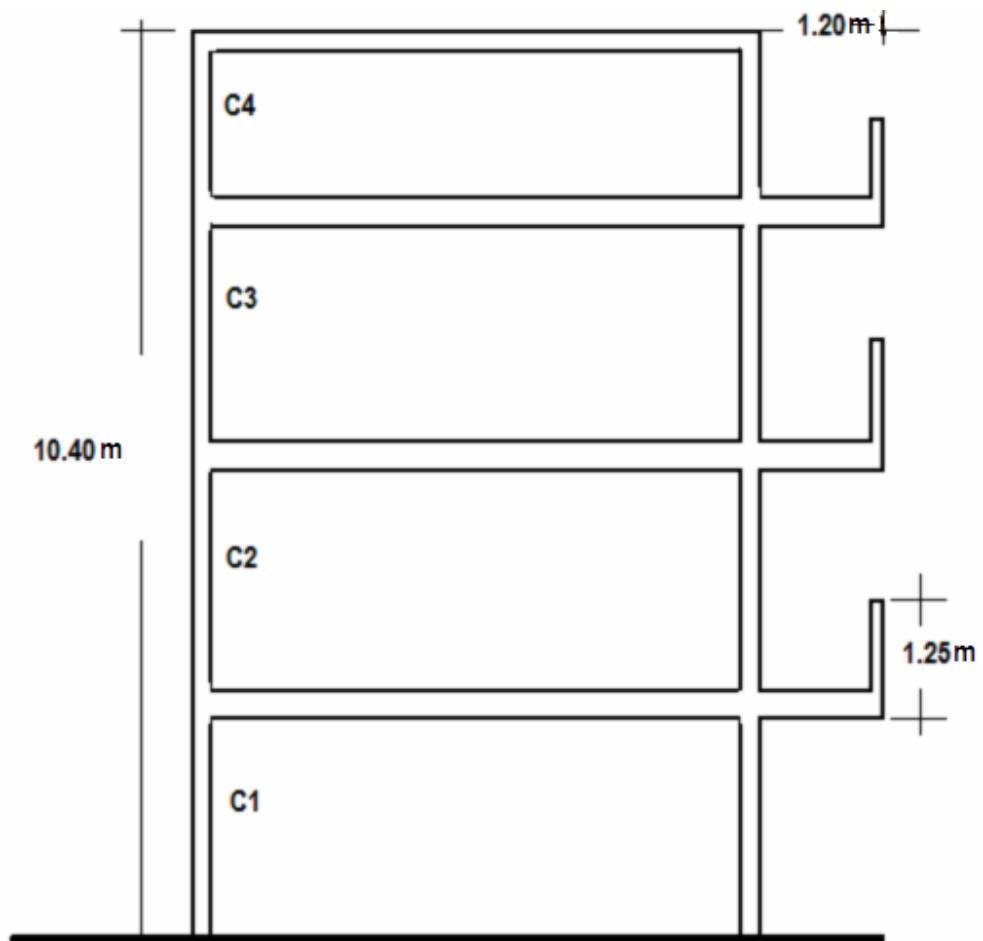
Anexo 8. Elevación estructural lateral de edificio
